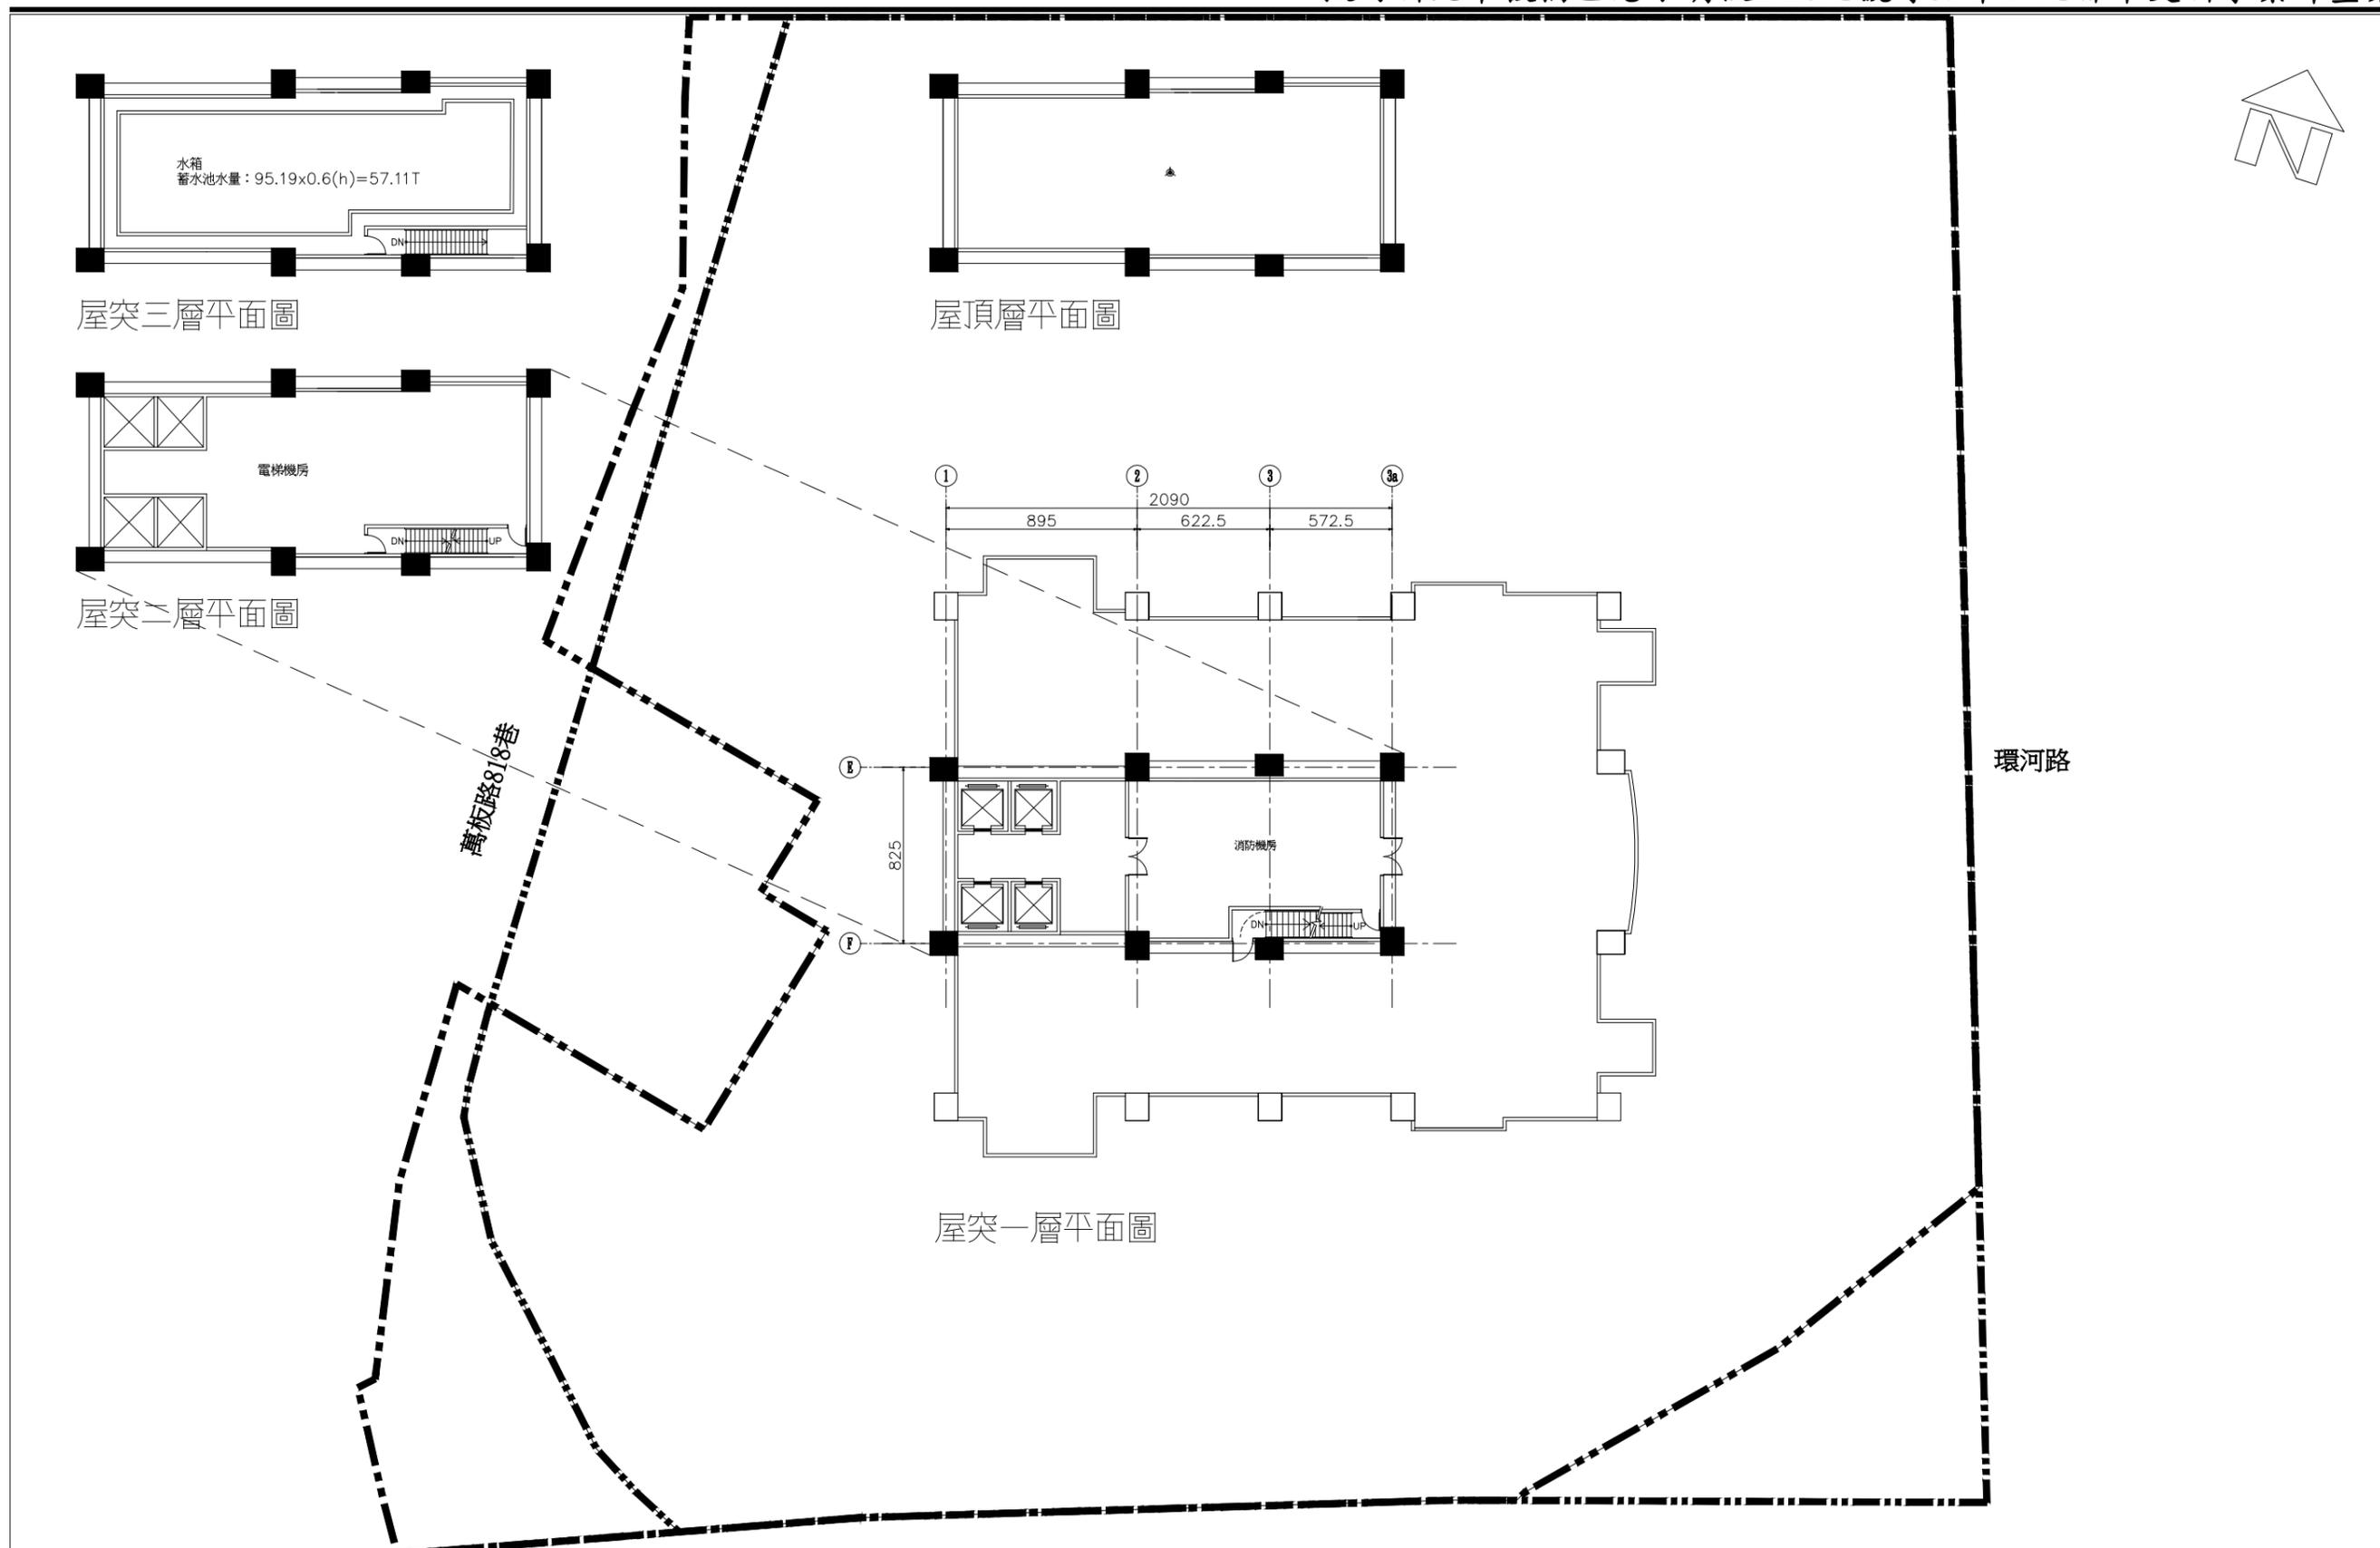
、屋突一至屋突三層平面圖 (S: 1/300)
